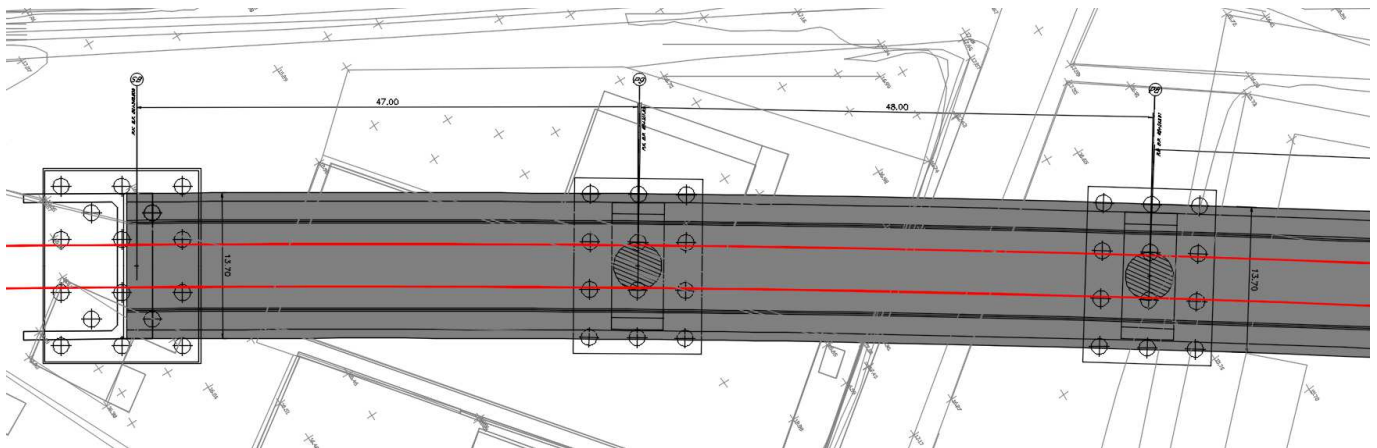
planimetria generale tra spalla B e Pila 8
